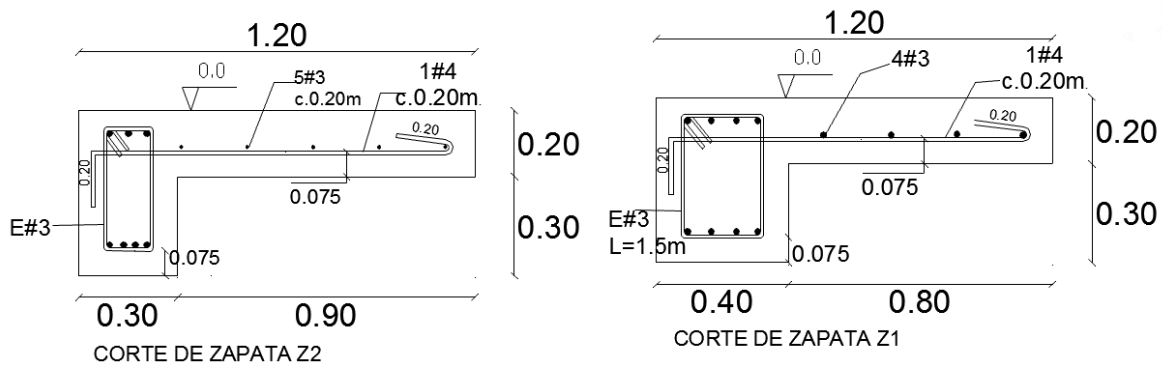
Corte de zapata Z1 y Z2. Fuente: Arquitecto.
